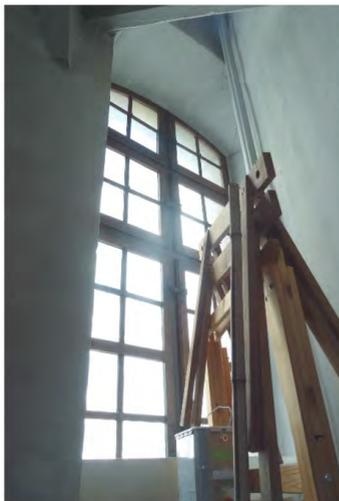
Fenêtre 12. Fenêtre à la française en arc bombé (segmentaire). Cette fenêtre est située dans la cage d'escalier. Façade Sud.
